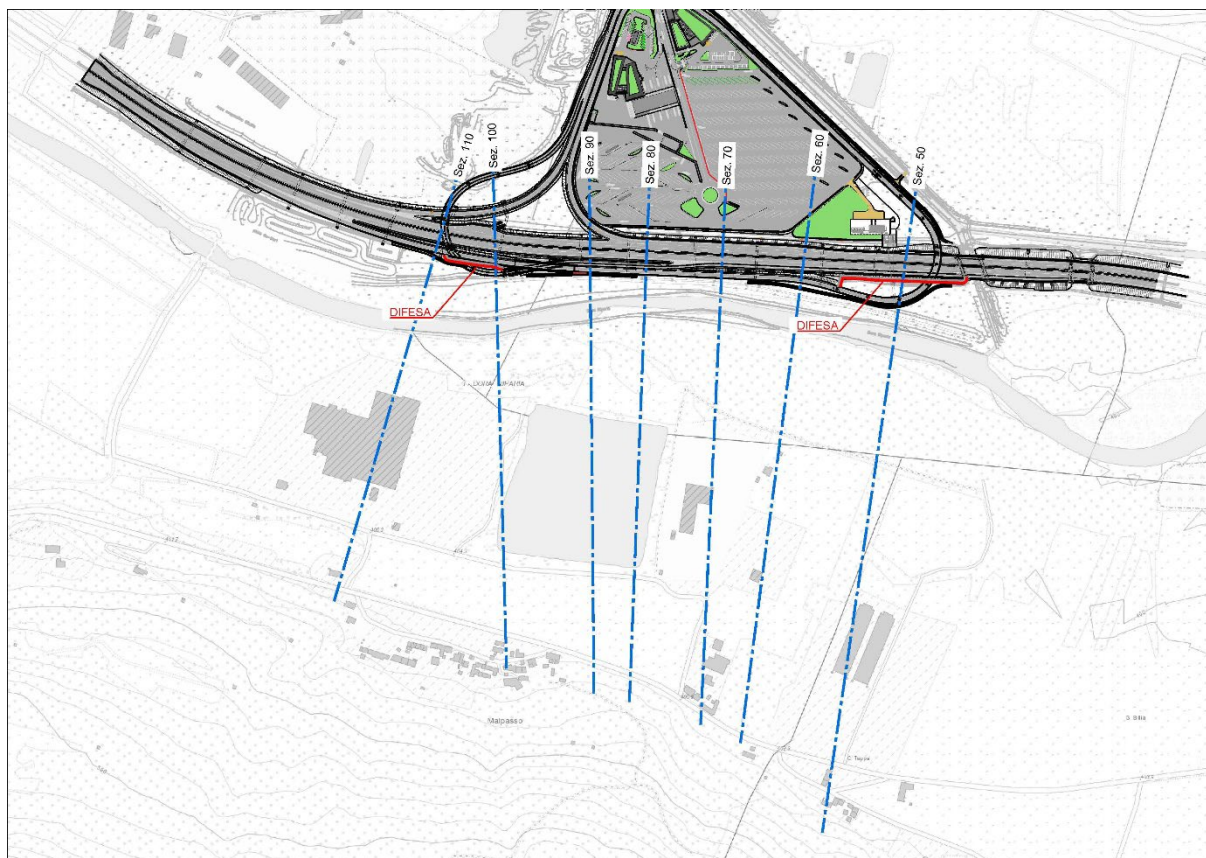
planimetria di individuazione delle sezioni idrauliche su CTR
